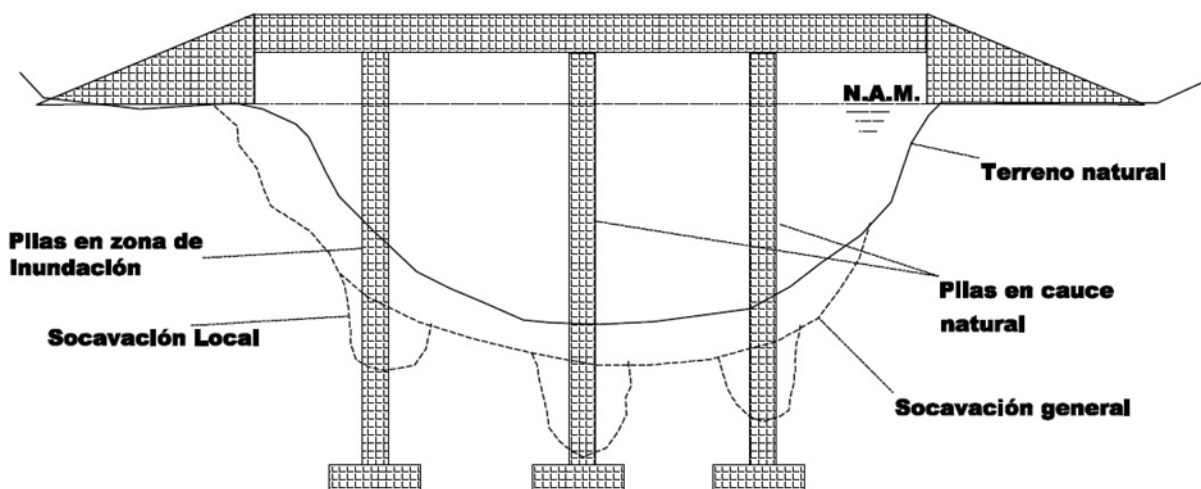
Elevación de las cimentaciones de las pilas en el cauce principal. (MOP-DACGER)
